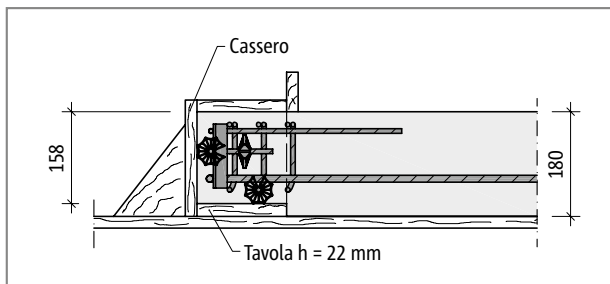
Schöck Tronsole® tipo Z, esecuzione di una mensola d'appoggio sul pianerottolo prefabbricato; spessore del pianerottolo  $h = 180$  mm
